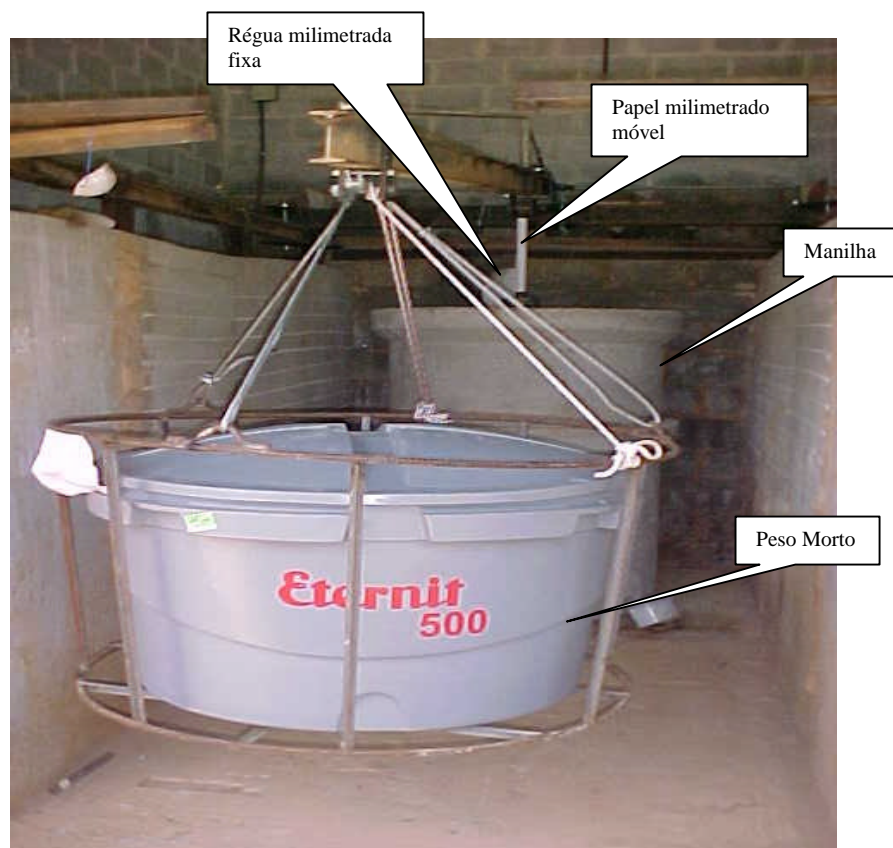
Vista do sistema de ligação da caixa d'água com a viga metálica.
